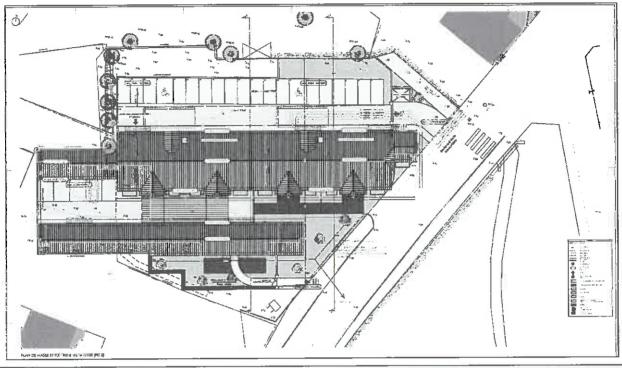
PLAN DU PROJET (SOURCE: LAMOTTE) - ECHELLE MODIFIEE
